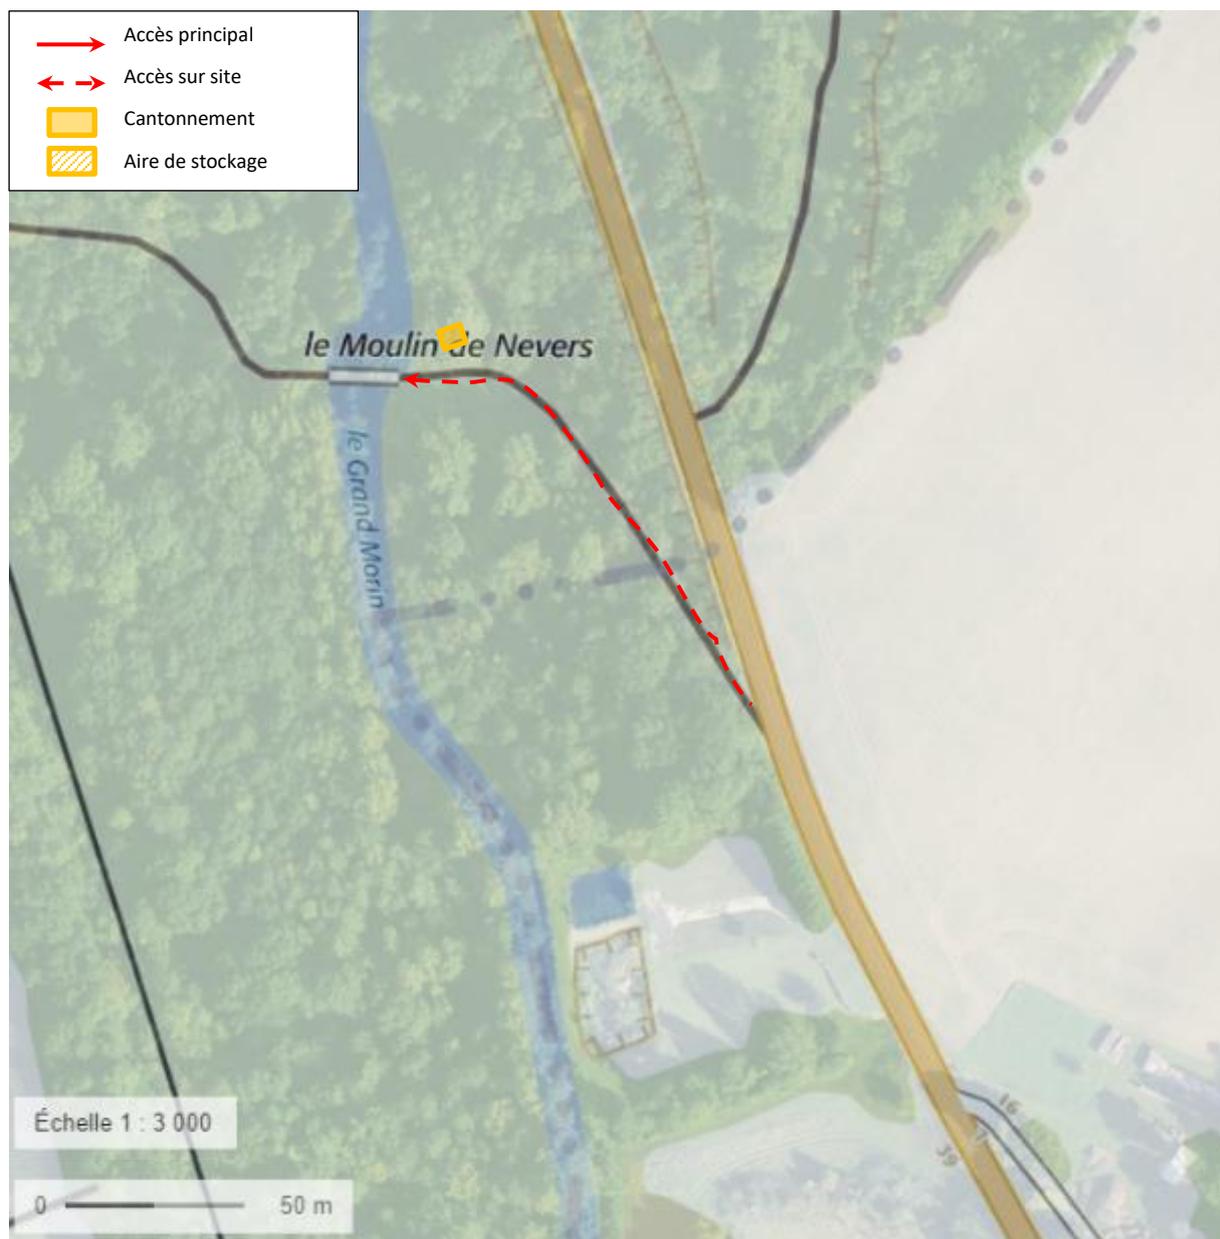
Accès et installation de chantier – Ouvrage du moulin de Nevers
